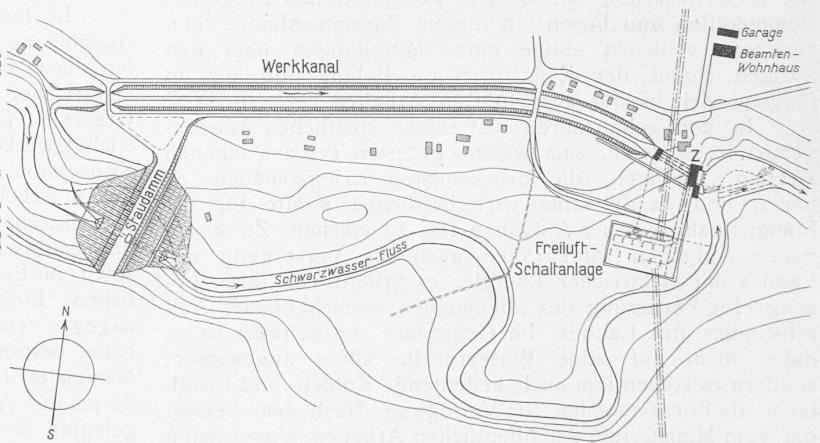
Kraftwerk Zur in Polen (Pomerellen). — Lageplan 1 : 10 000.
